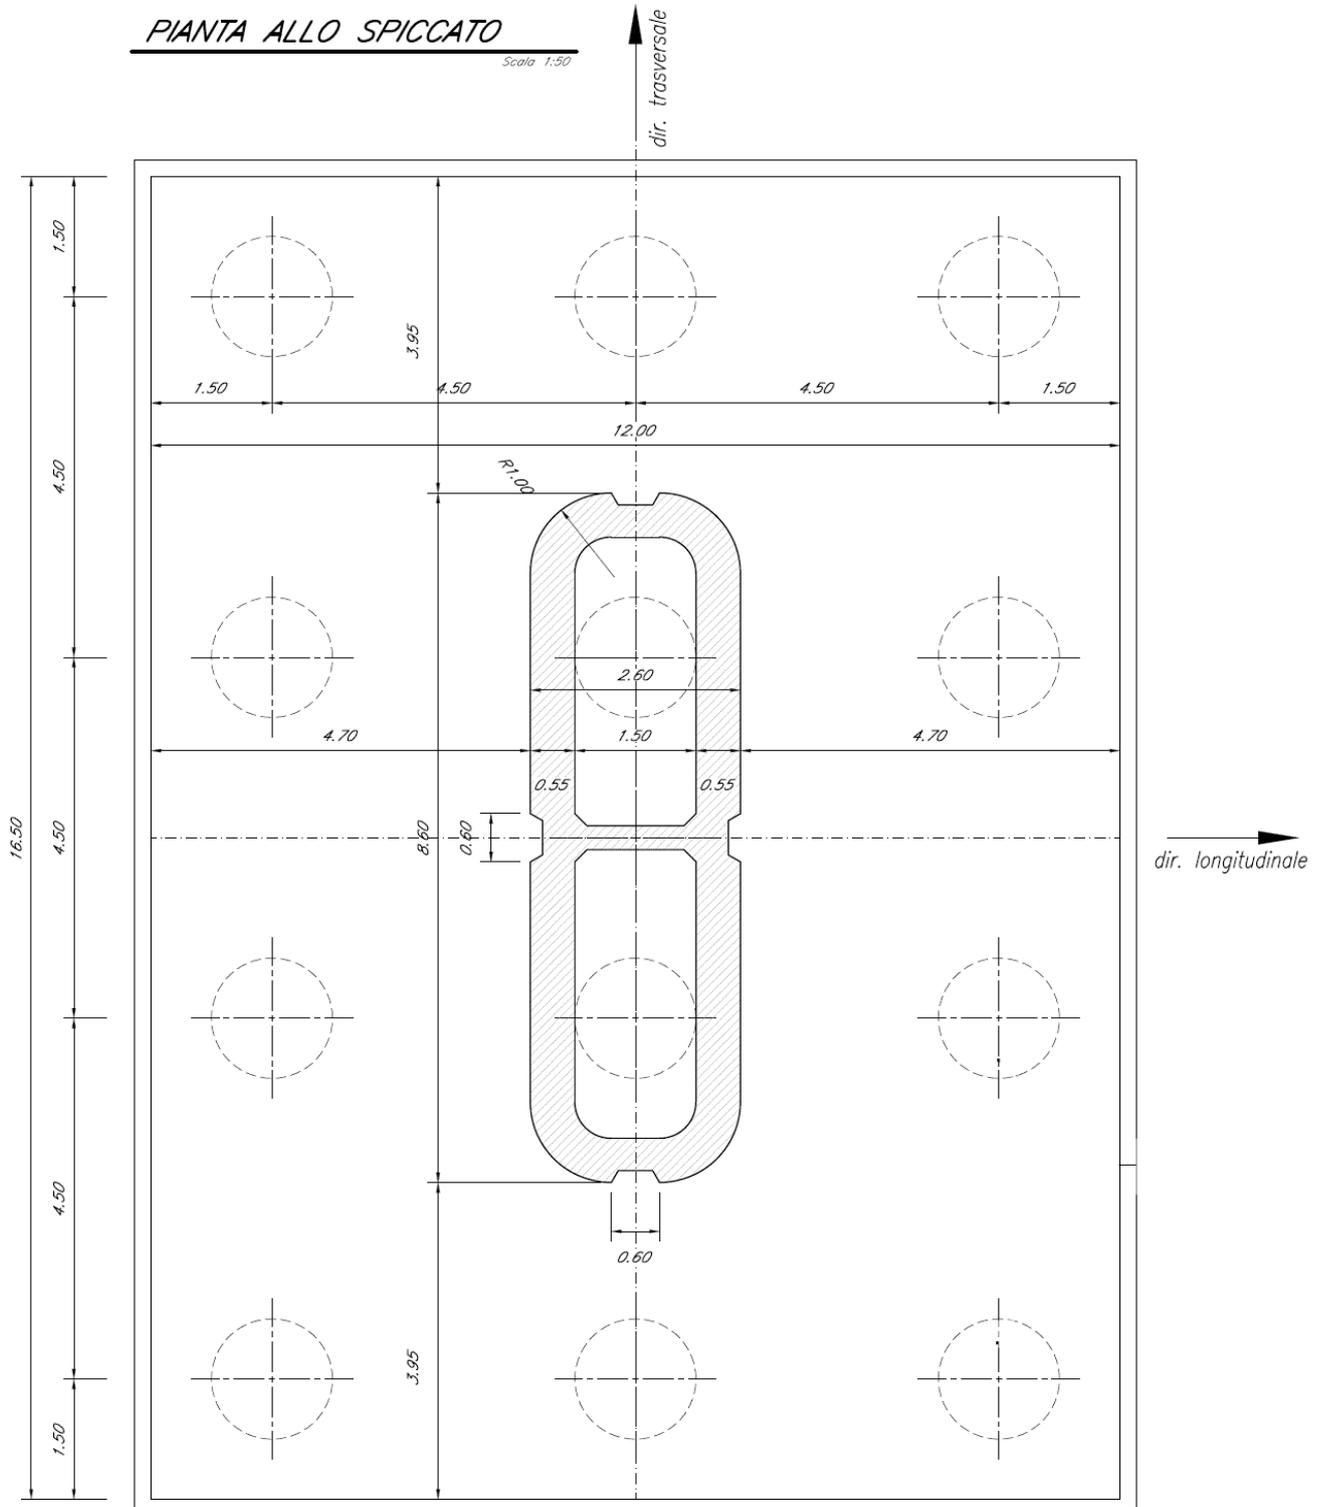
Plinto di fondazione e pali, vista in pianta - Sezione del fusto pile [m]
